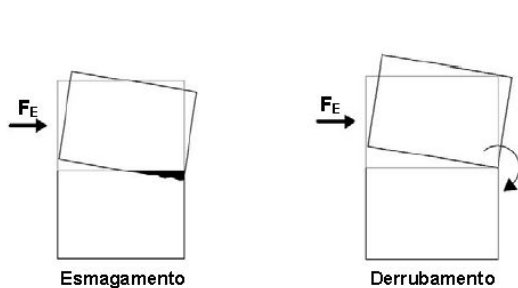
Mecanismo de rotura para fora do plano da parede (Pereira, 2009)
